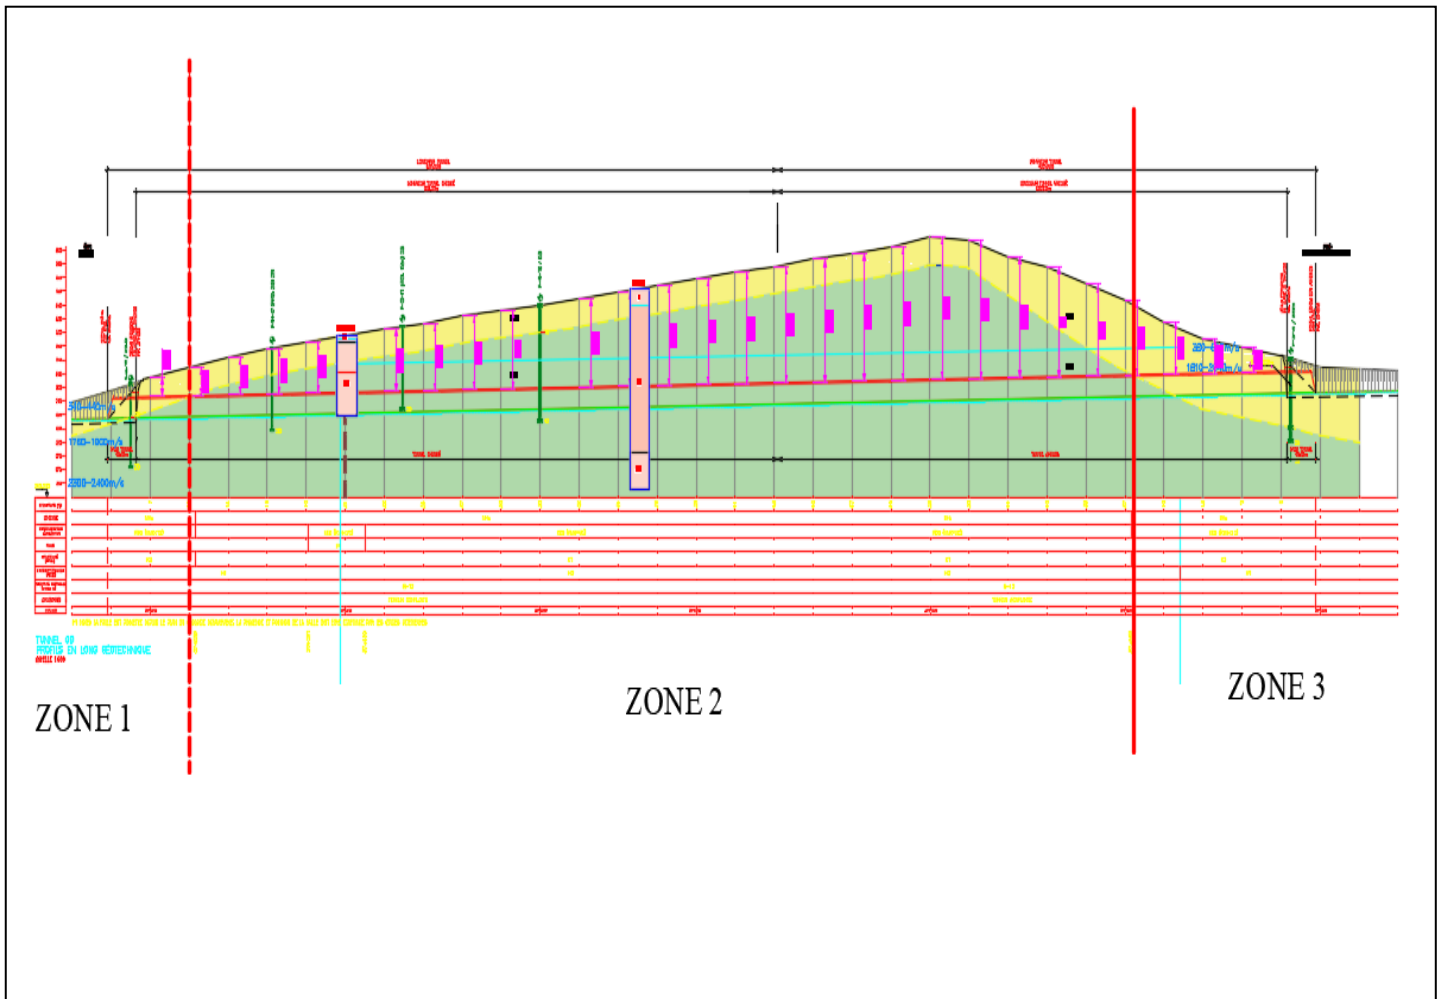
Coupe géologique et profile en long du tunnel entre le PK 37+290 et 37+900
